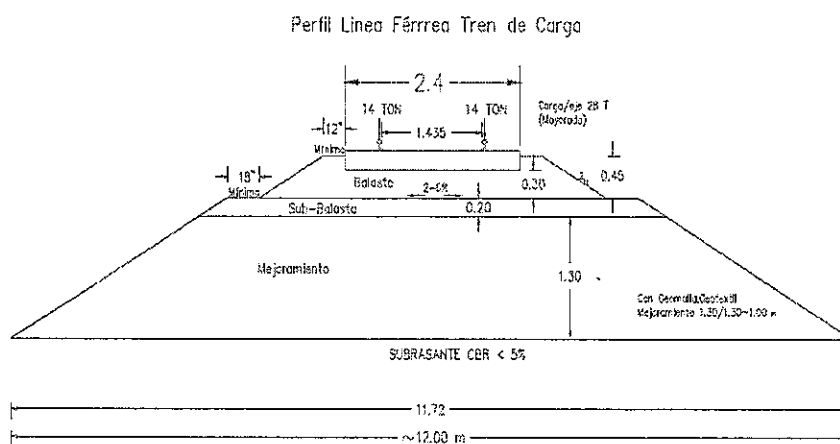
Sección transversal corredor Puerto Posorja-Daule (unidades en mm)
